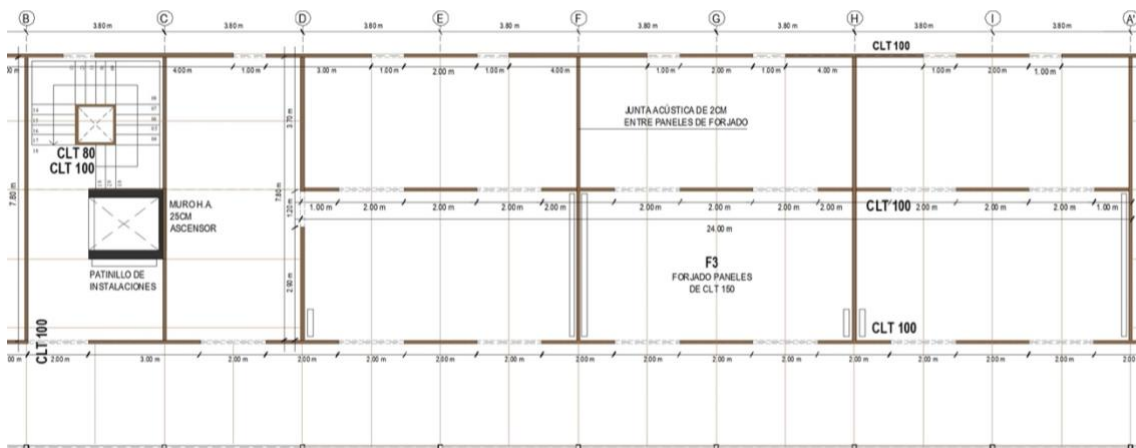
Detalle de planta tipo de estructura de madera. Techo de planta primera.
